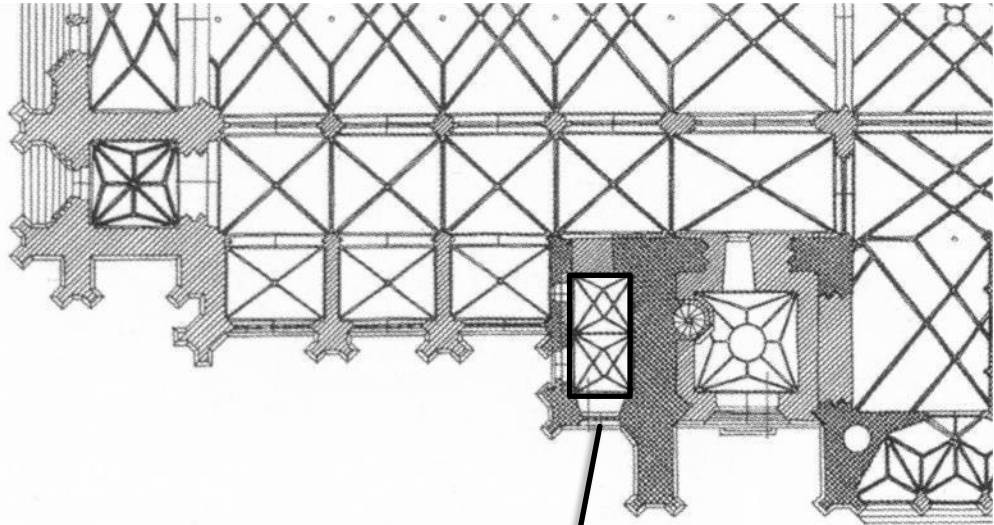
St. Wendel, St. Wendalinus, Grundriss
